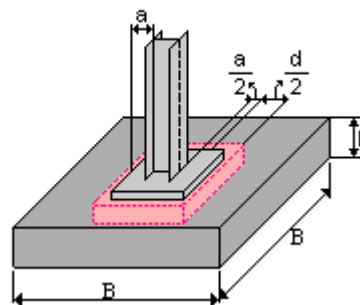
Cortante Bidireccional en Zapata que Soporta Columna de Acero.
